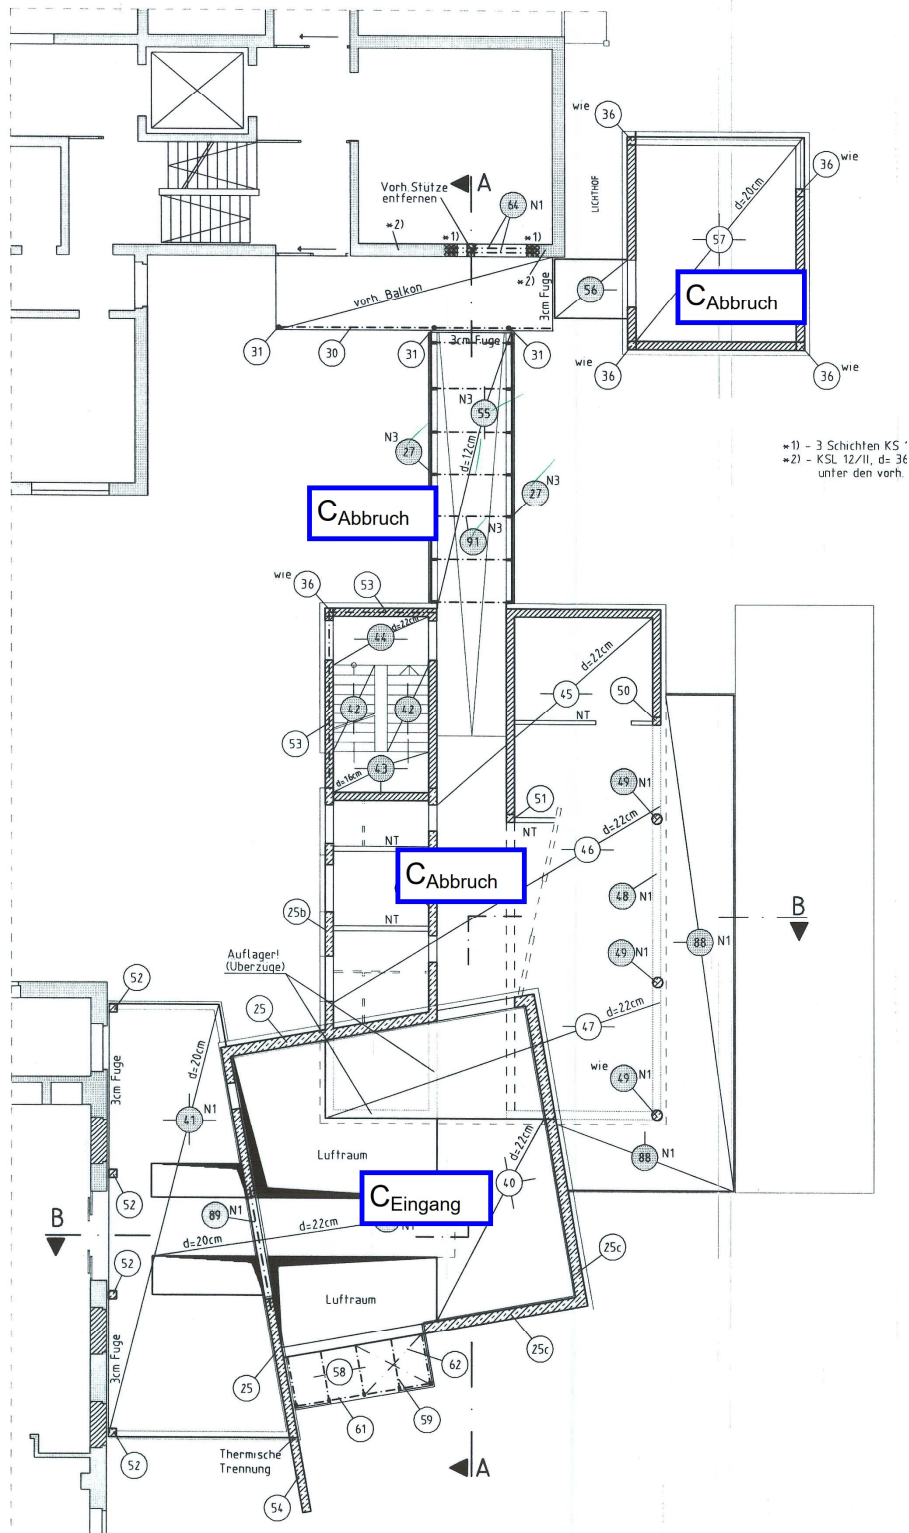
Auszug Positionsplan Grundriss EG P3b vom 29.09.2003
